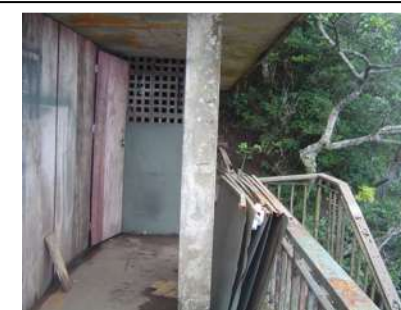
Área de mirante: inadequação de uso e degradação dos elementos: estruturas metálicas, alvenaria e piso.
